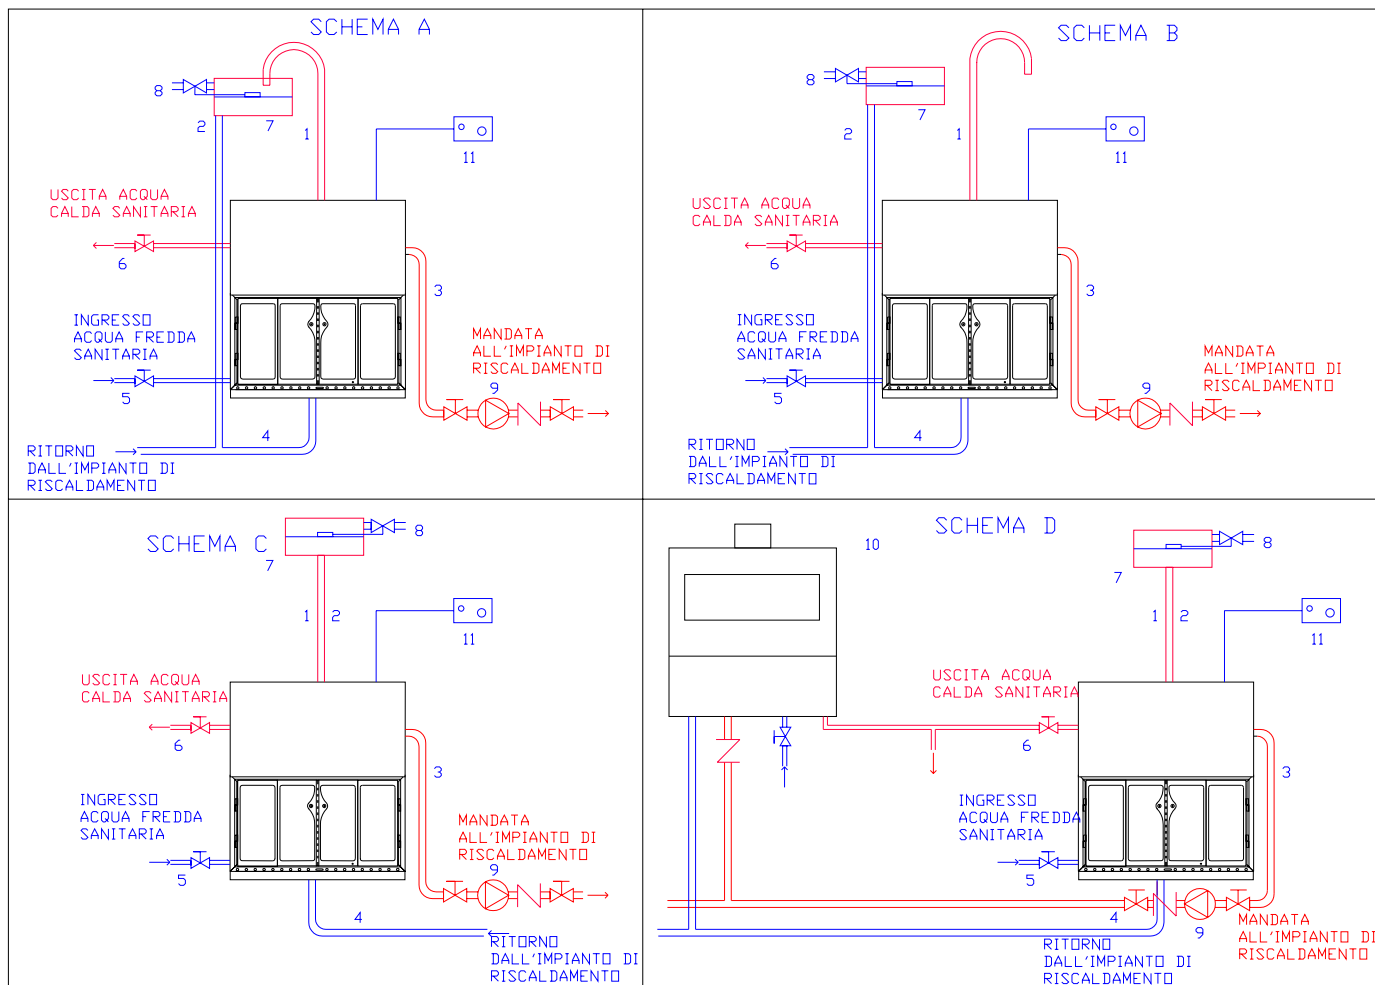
SCHEMA DI COLLEGAMENTO MERCURY 35 AD IMPIANTO TRADIZIONALE
